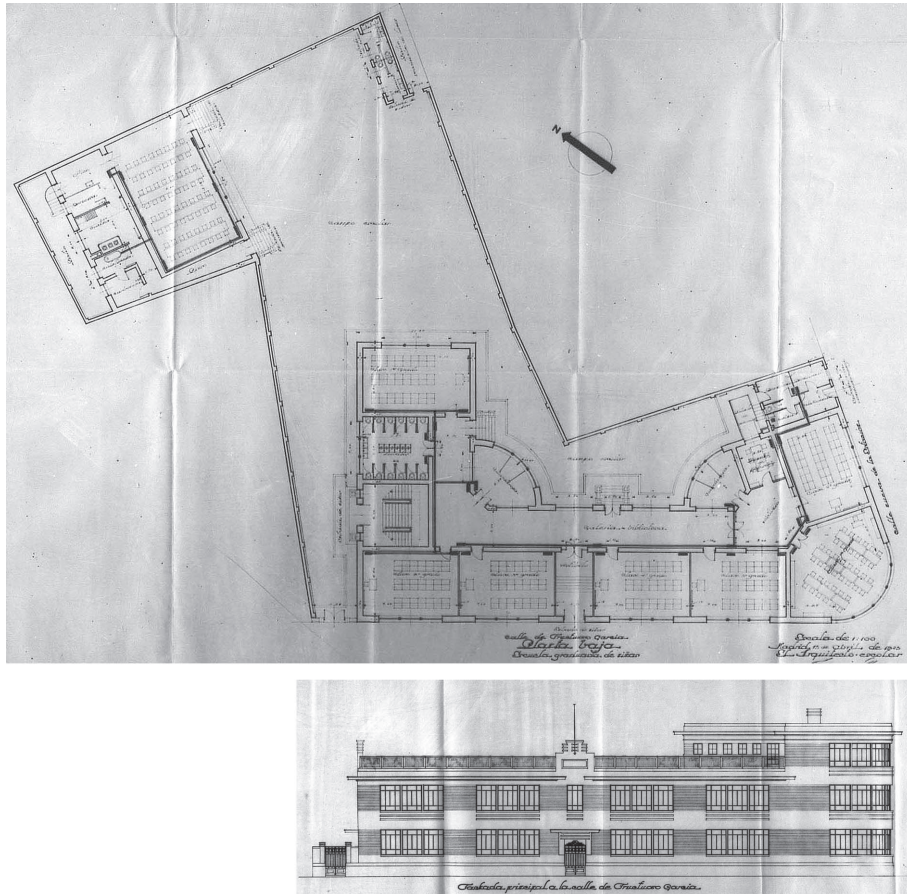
Grupo escolar San Fernando según proyecto original de Joaquín Muro (Valladolid, 1932): planta baja del conjunto y alzado suroeste (Fuente: Archivo General de la Administración).
